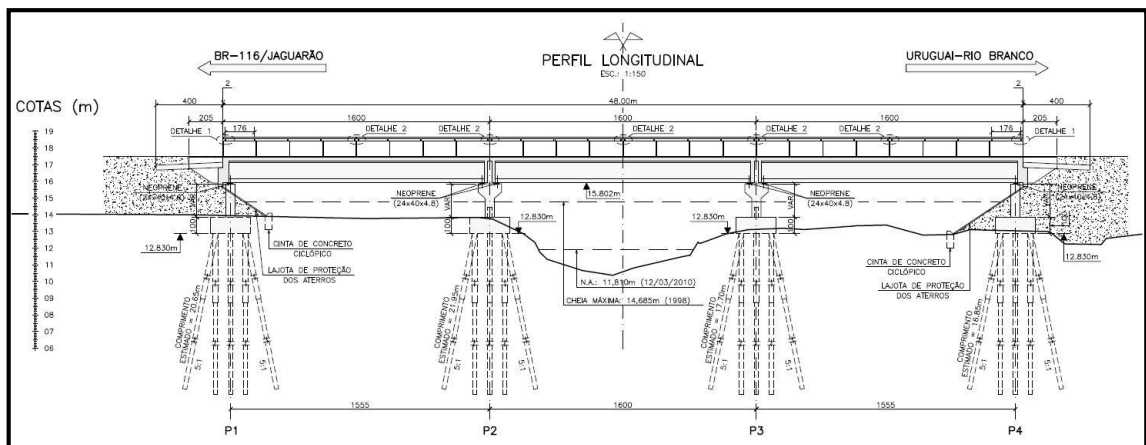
Ponte sobre o Arroio Lagoões – Perfil Longitudinal.
